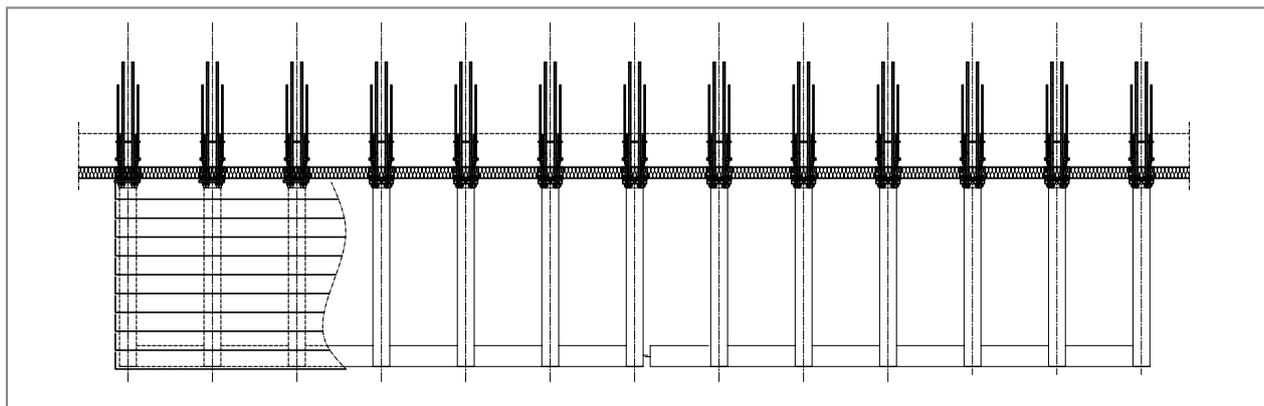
Schöck Isokorb® T type SK : Balcon en porte-à-faux
